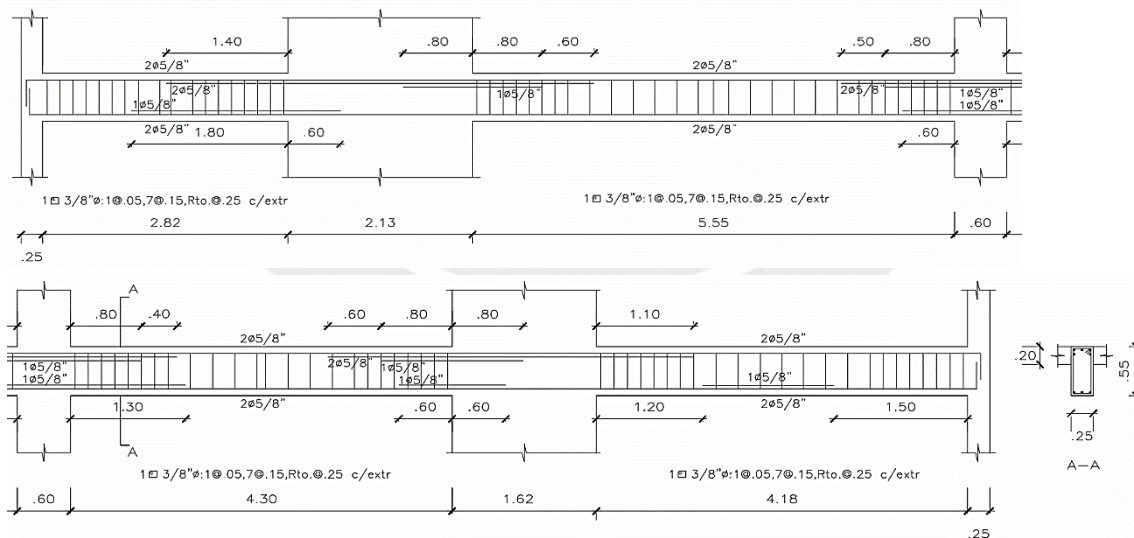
Detalle de armado de la viga VT-02 de sistema de muros
